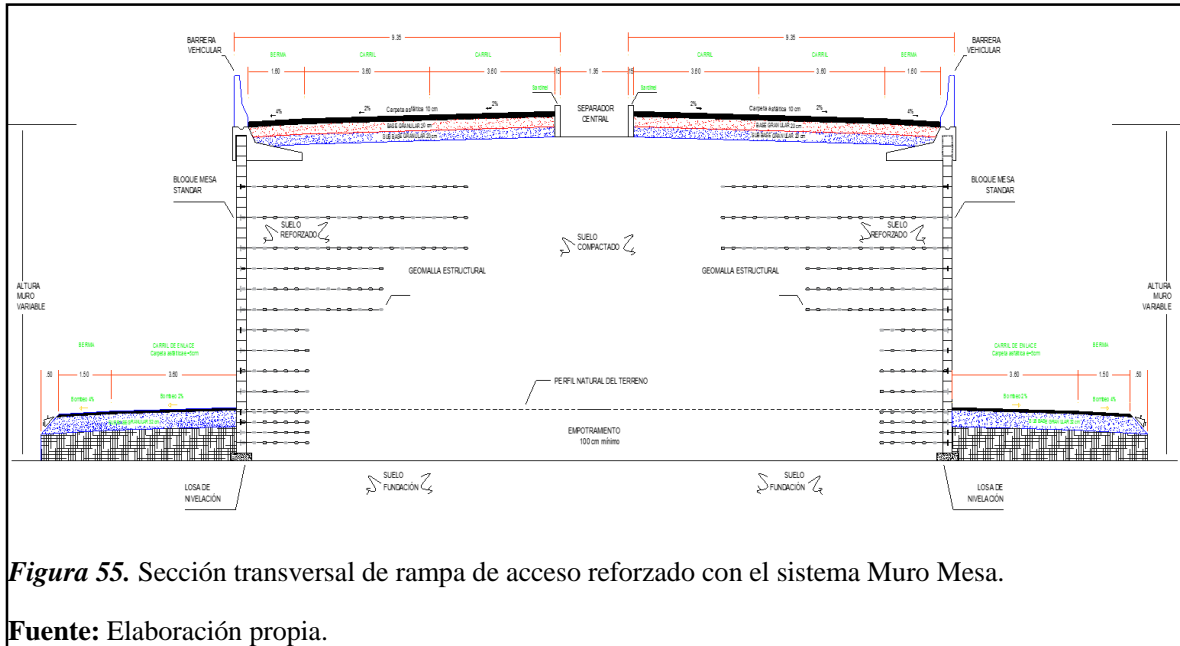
Sección transversal de rampa de acceso reforzado con el sistema Muro Mesa.
